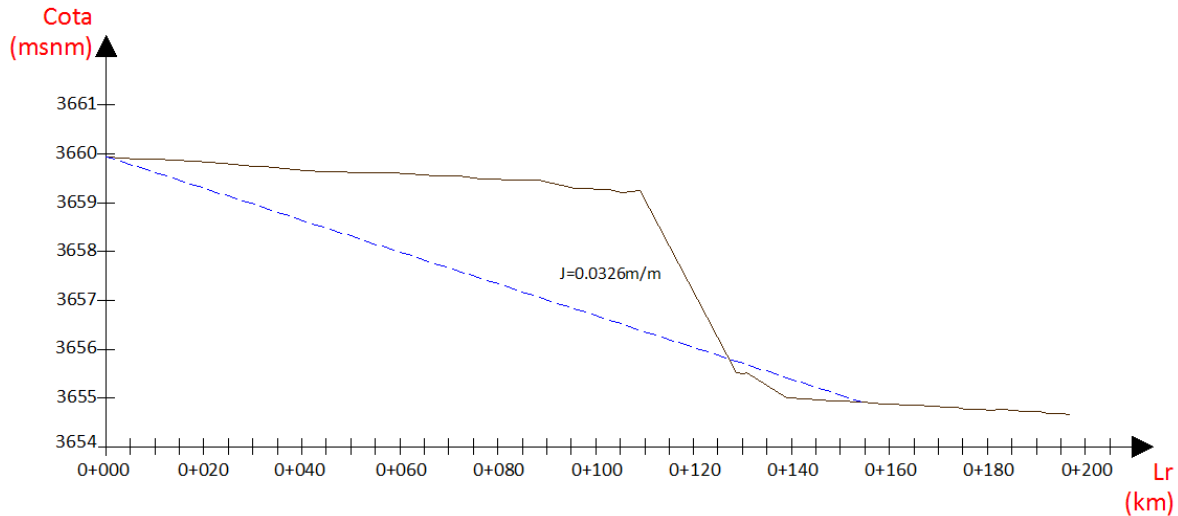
Perfil longitudinal y pendiente de la alcantarilla
